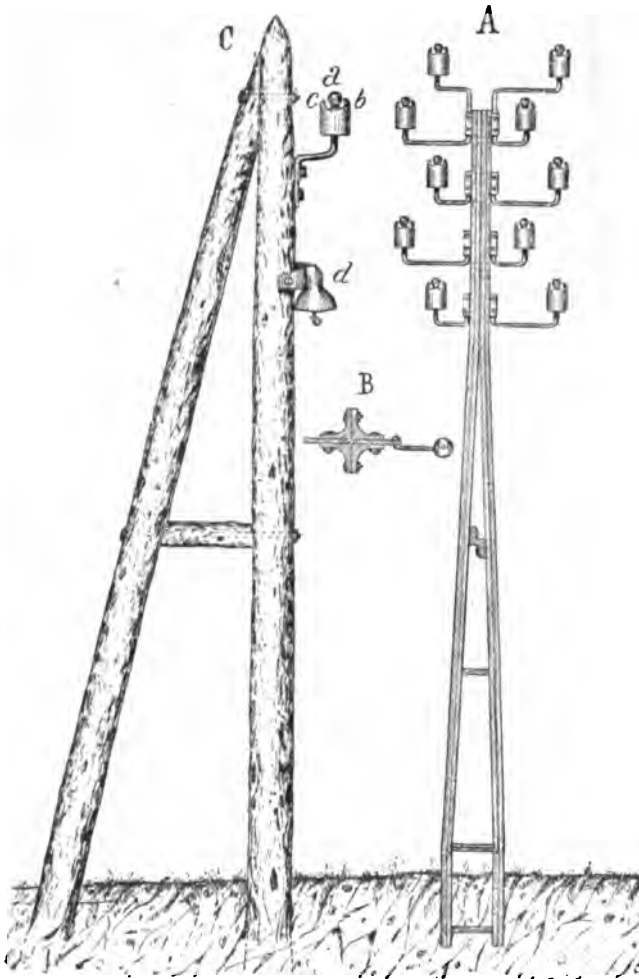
Poteau en fer Lemasson et poteaux couplés.
